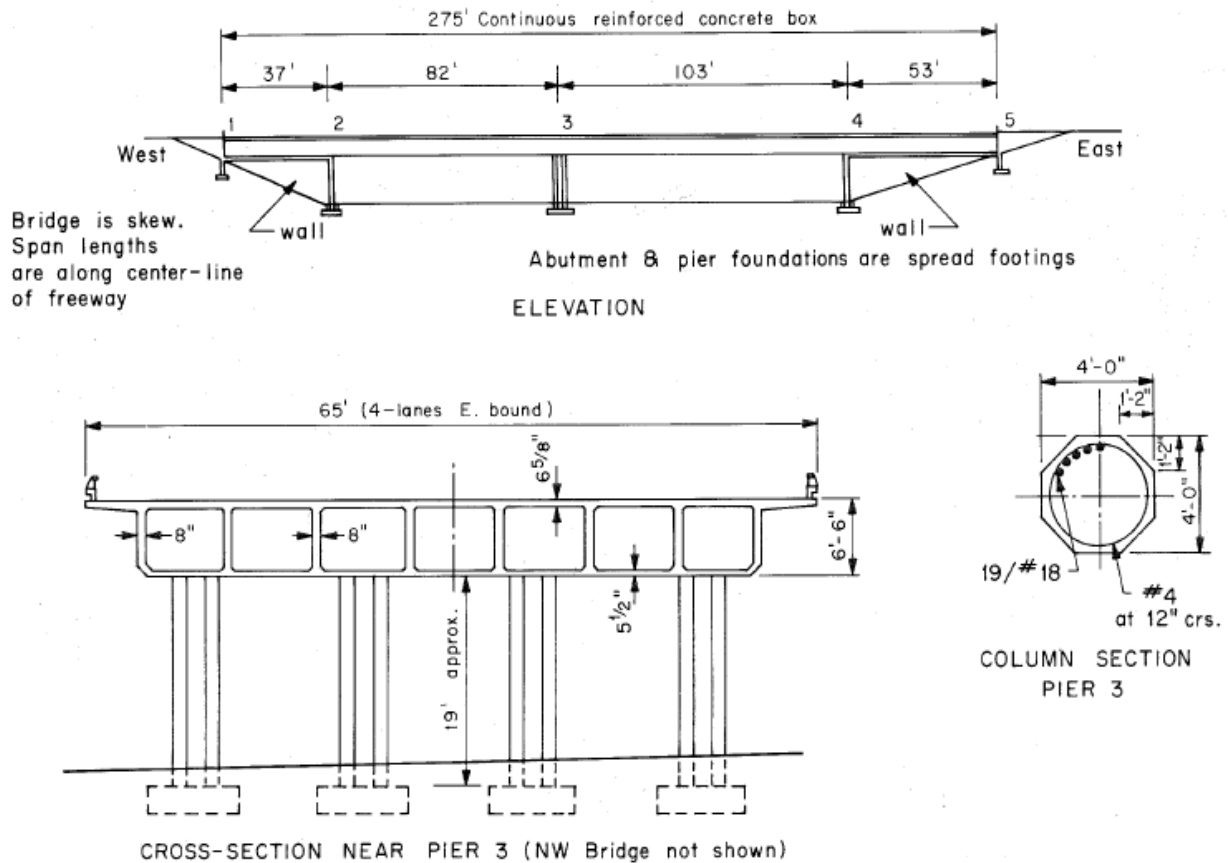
Elevación y Sección Transversal del Puente Sur-este del Paso Inferior Foothill Boulevard. Fuente: [9].
